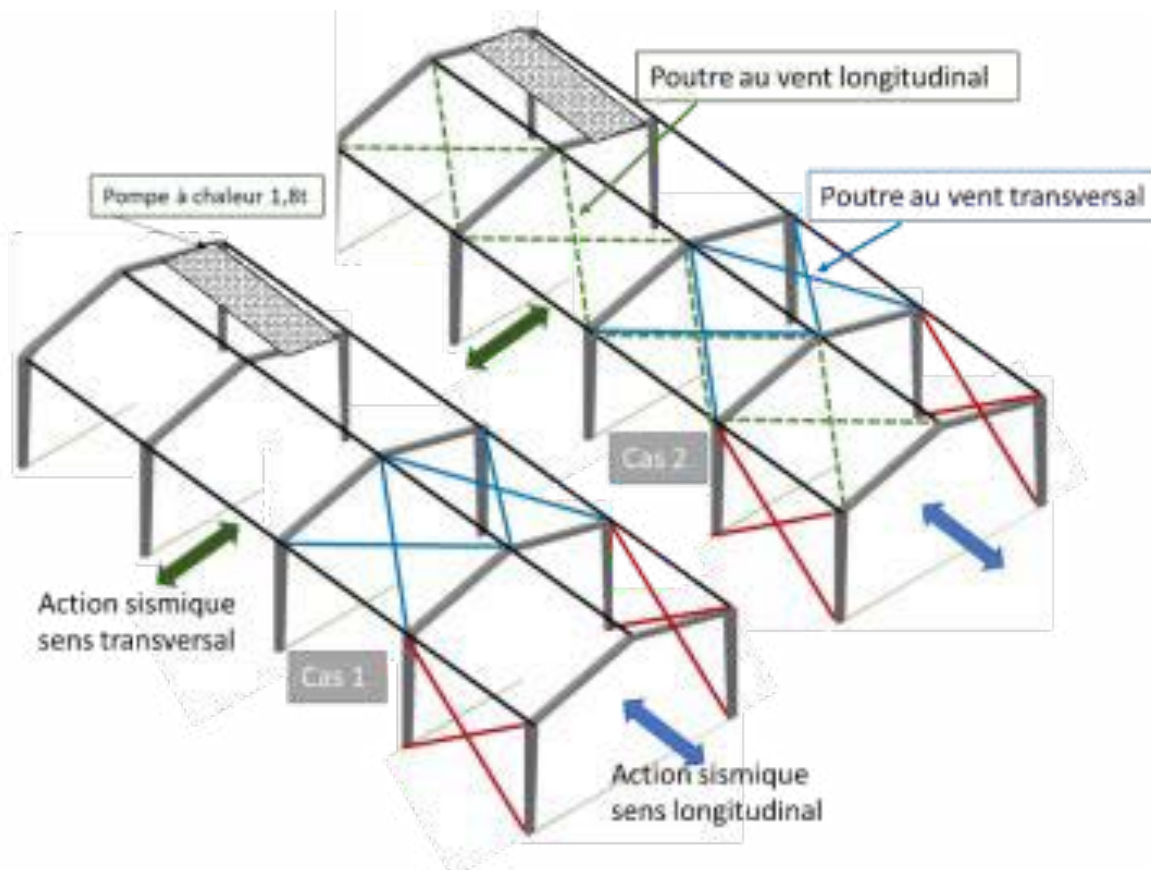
Illustration du principe de diaphragme en toiture : cas 1) sans poutre longitudinale au vent ; cas2) avec poutre longitudinale au vent (AFPS). (Image basée sur une illustration issue du livre AFPS- Dispositions constructives parasismiques)
